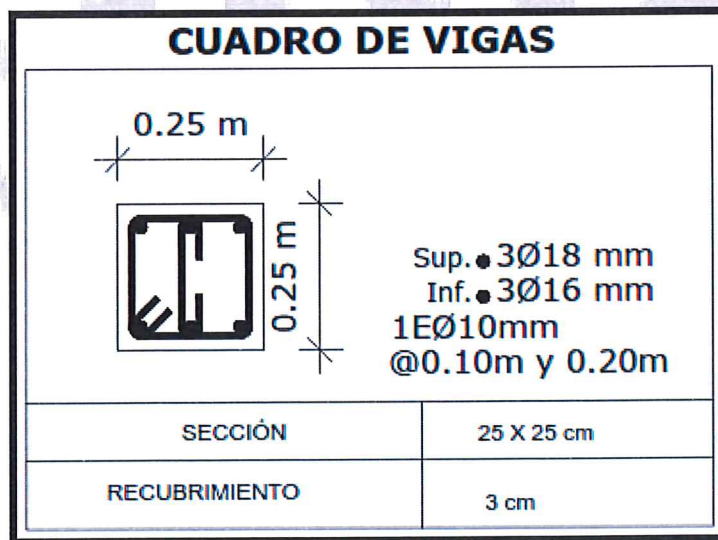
Esquema de armado de vigas, a partir del escaneo
